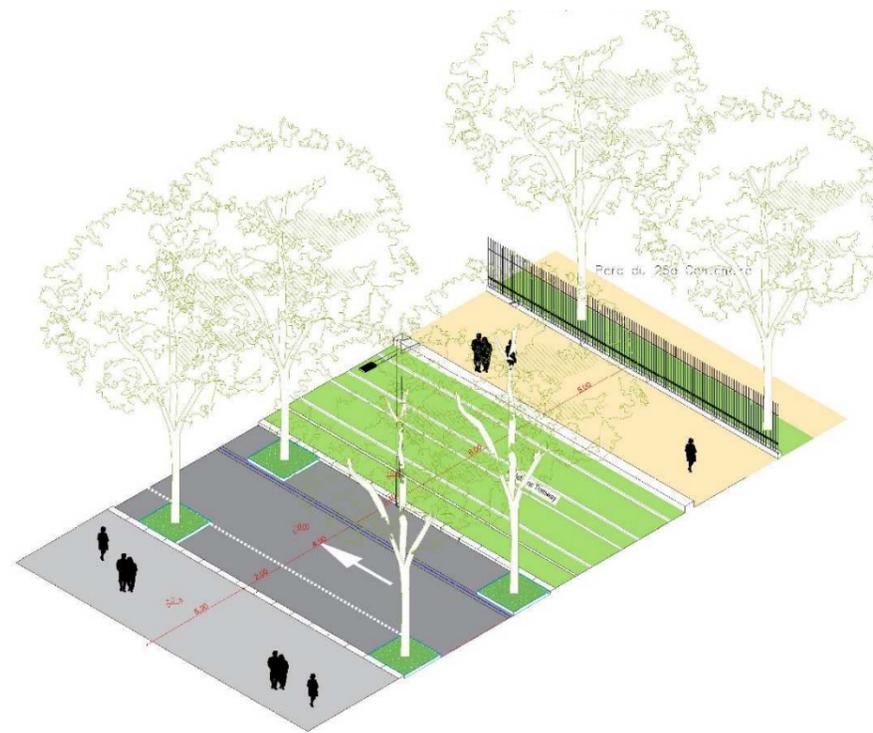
Profil de l'avenue Cantini le long du parc du XXVIème centenaire
